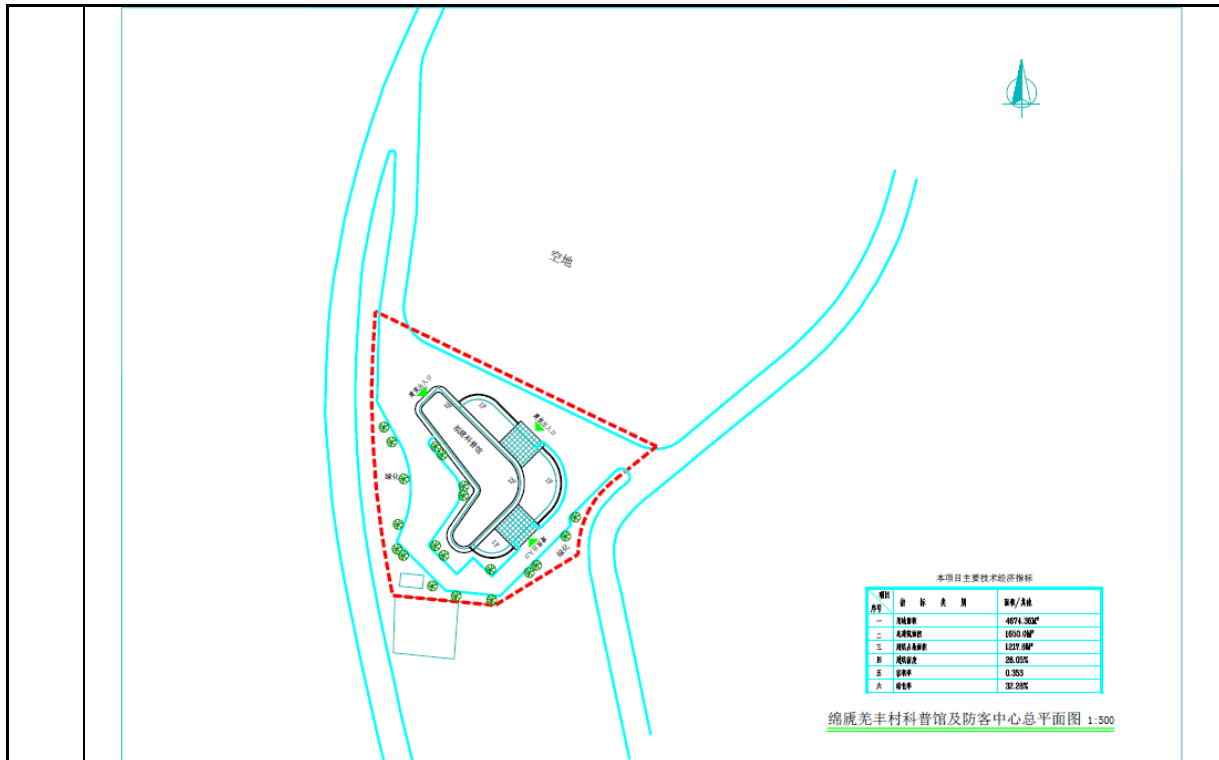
羌锋村部分科普馆及访客中心平面布置图
